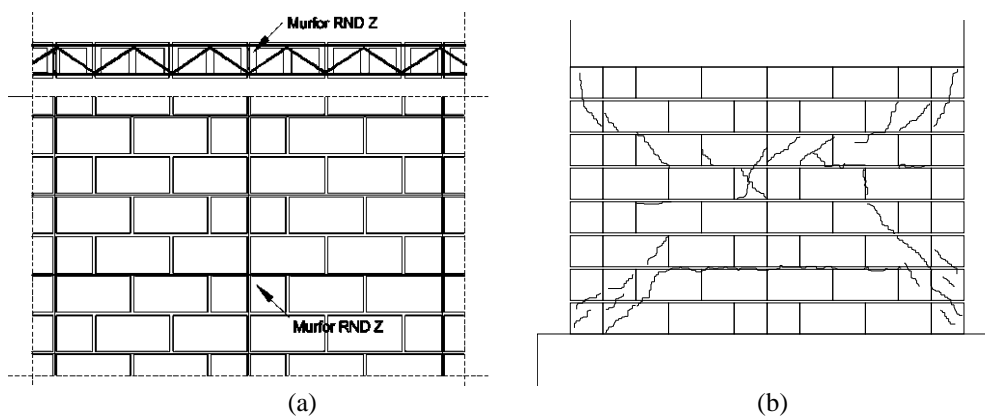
Alvenaria moderna armada (solução em desenvolvimento na Universidade do Minho em colaboração com a empresa Costa & Almeida, Lda): (a) solução adoptada para as armaduras verticais e horizontais; (b) padrão de fendilhação em paredes de corte submetidas a ações cíclicas [8].
